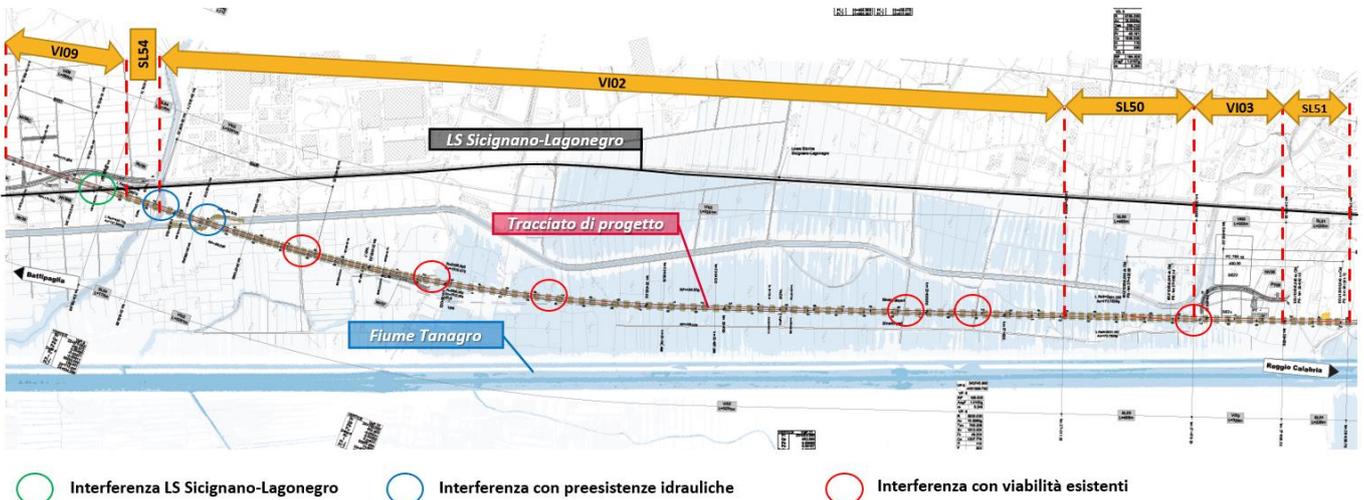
Planimetria aree allagabili da km 23+170 a km 28+266
